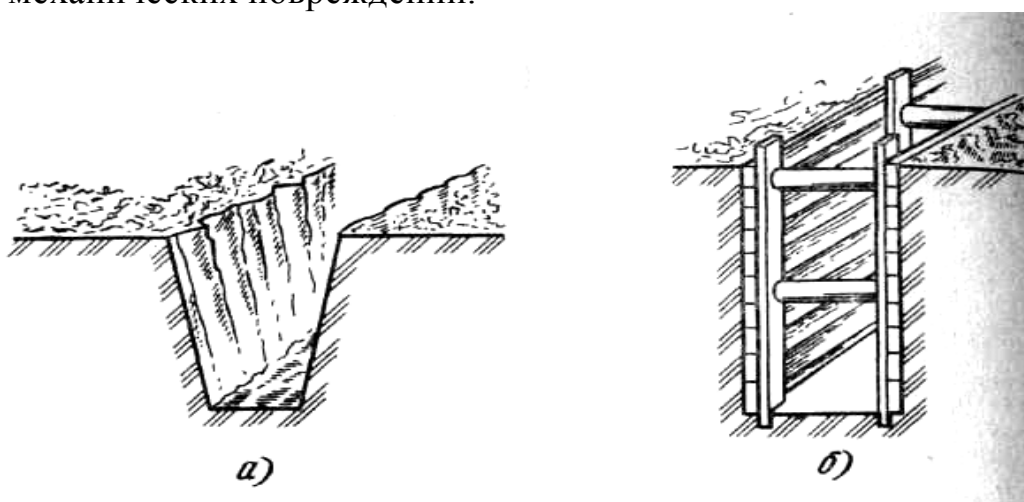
Траншея для прокладки кабеля: а — без крепления; б — с креплением.
